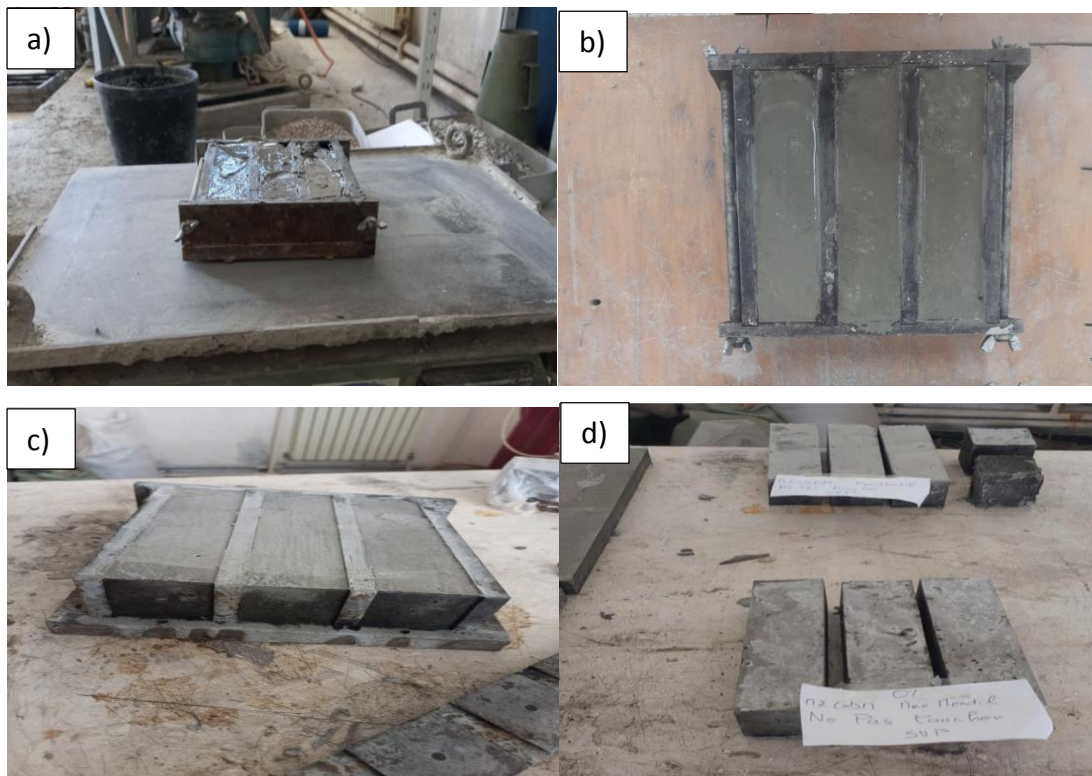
Procédure d'élaboration des composites Bois-Ciment. (a) et (b): moulage des éprouvettes. (c) : démoulage des éprouvettes. (d) : éprouvettes après 28 jours de séchage.
